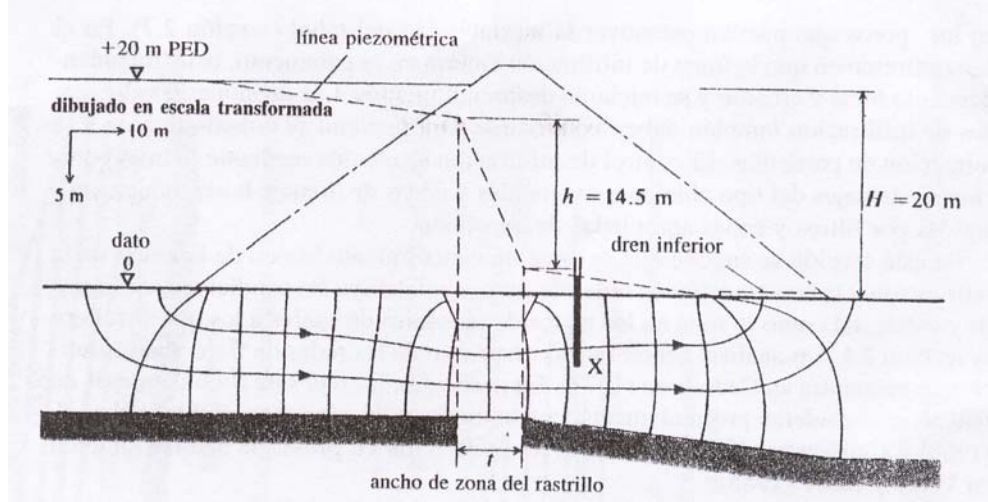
Red de flujo para la infiltración y la cimentación.
